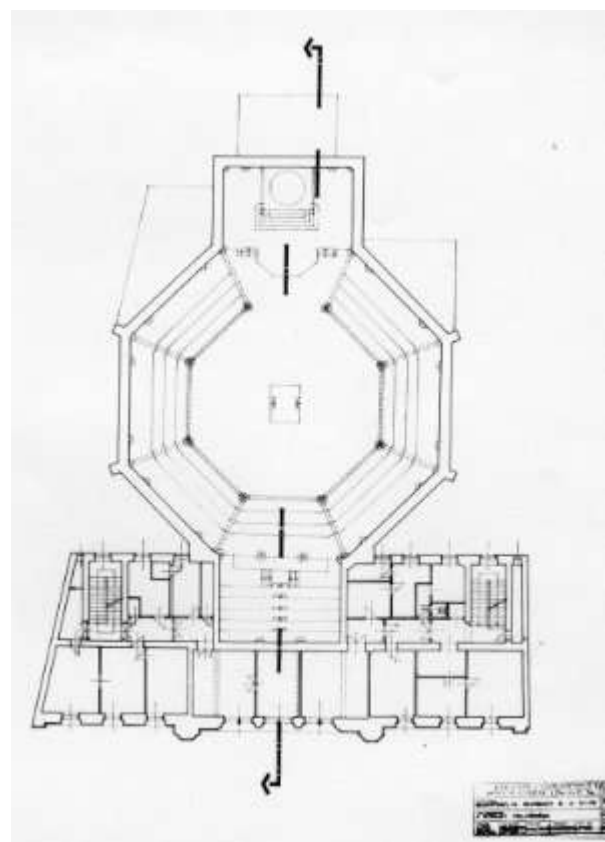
Grundriss 1. Obergeschoß 1971 Vermesserplan 1971
